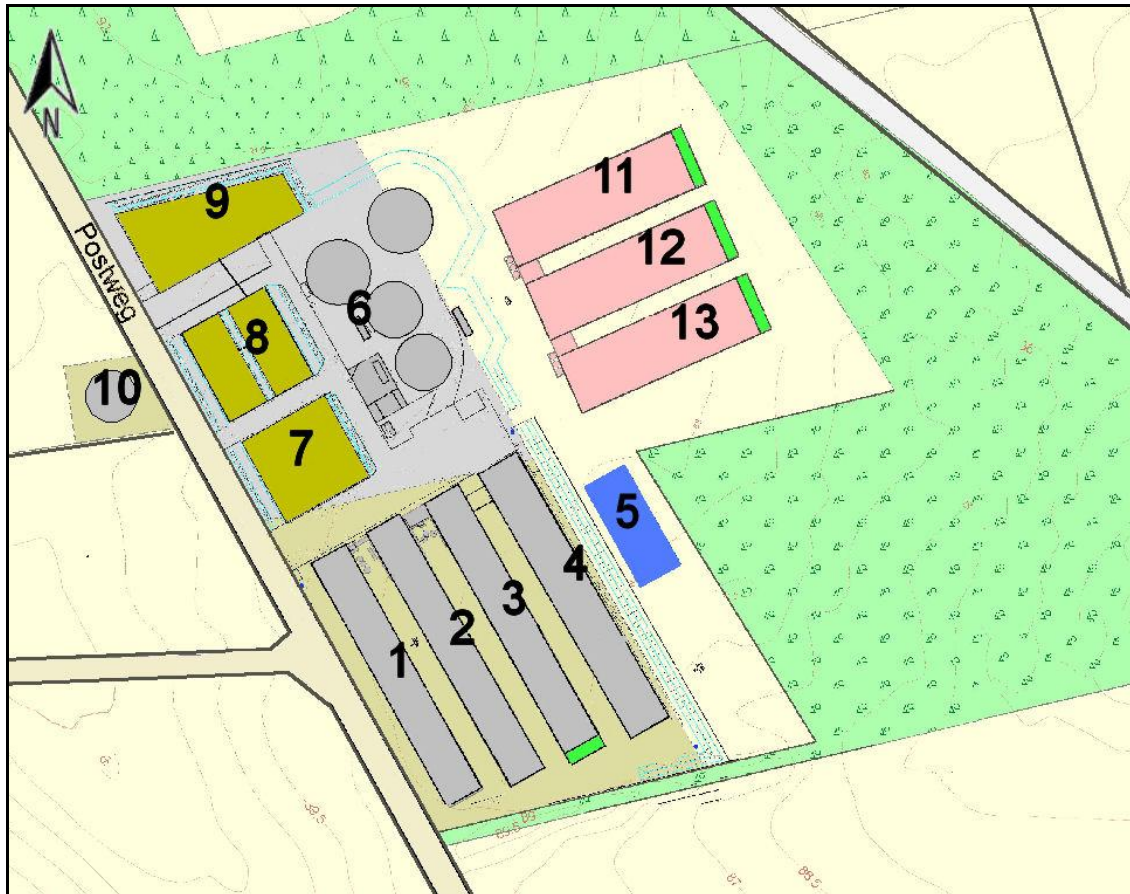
Gebäudeplan der vorhandenen Biogasanlage sowie der vorhandenen und geplanten Masthähnchenställe im Außenbereich von Ohrdorf. M 1: ~3.200
